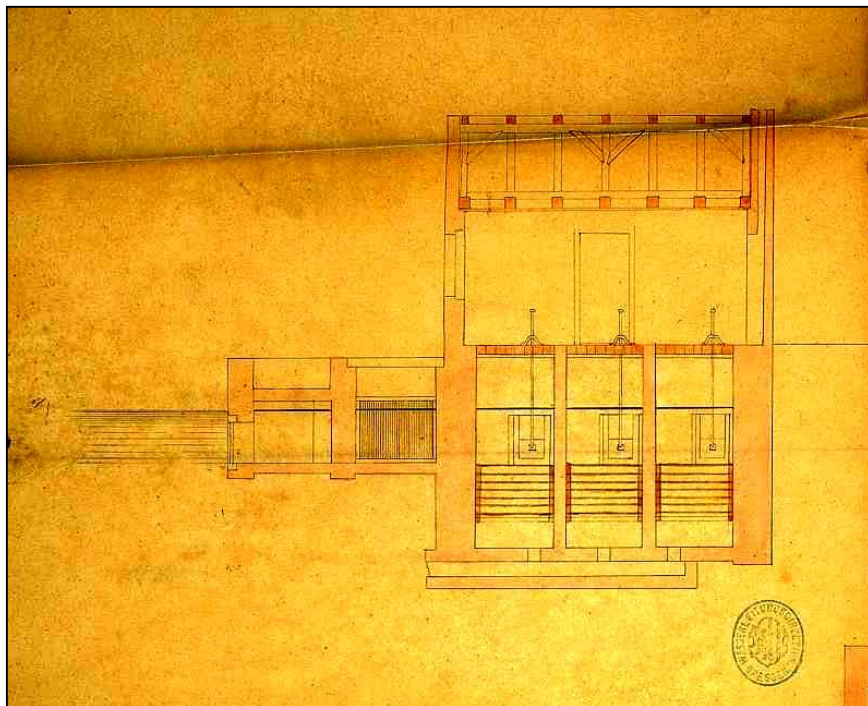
Lageplan des hochplauenschen Wasserhauses 1862
